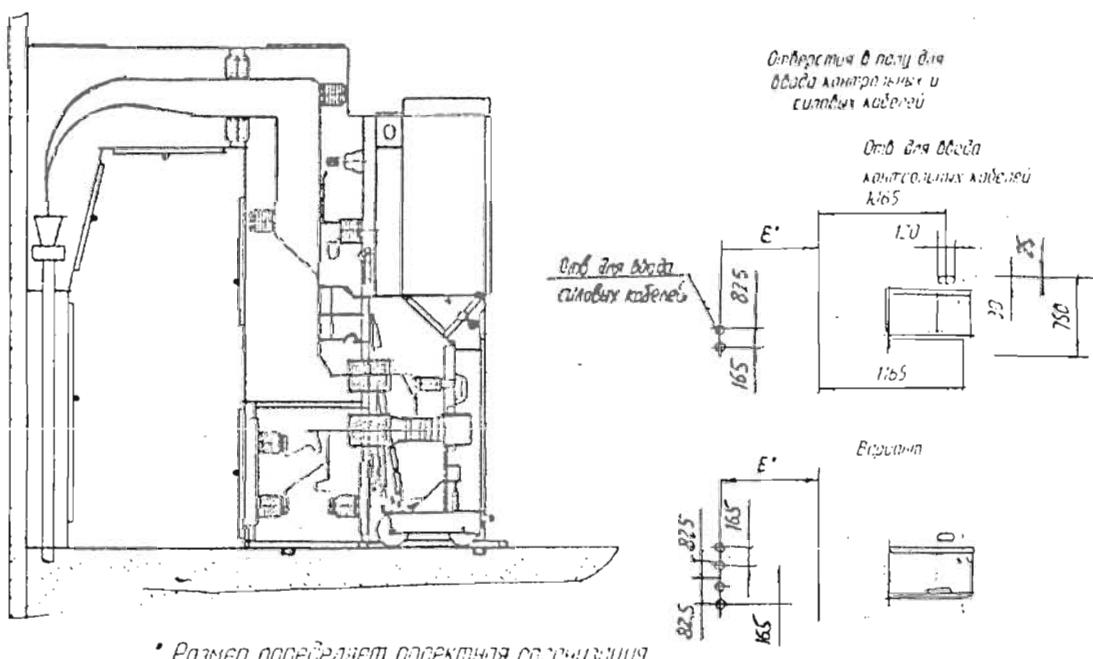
Установка накафа кабельного ввода с подключением вне накафа на фундамент
